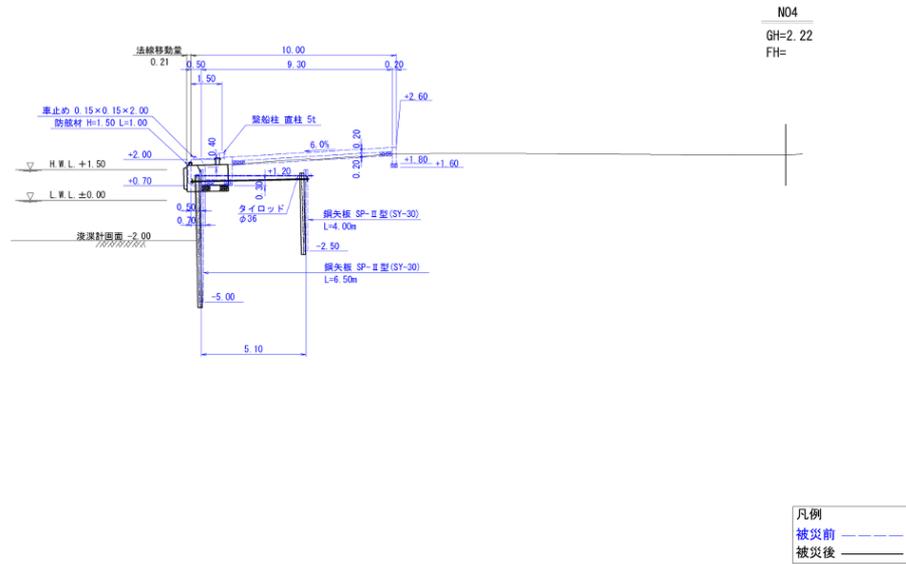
No.15 日立港区_第5埠頭地区第2船だまりの東1断面図(被災前・後)
